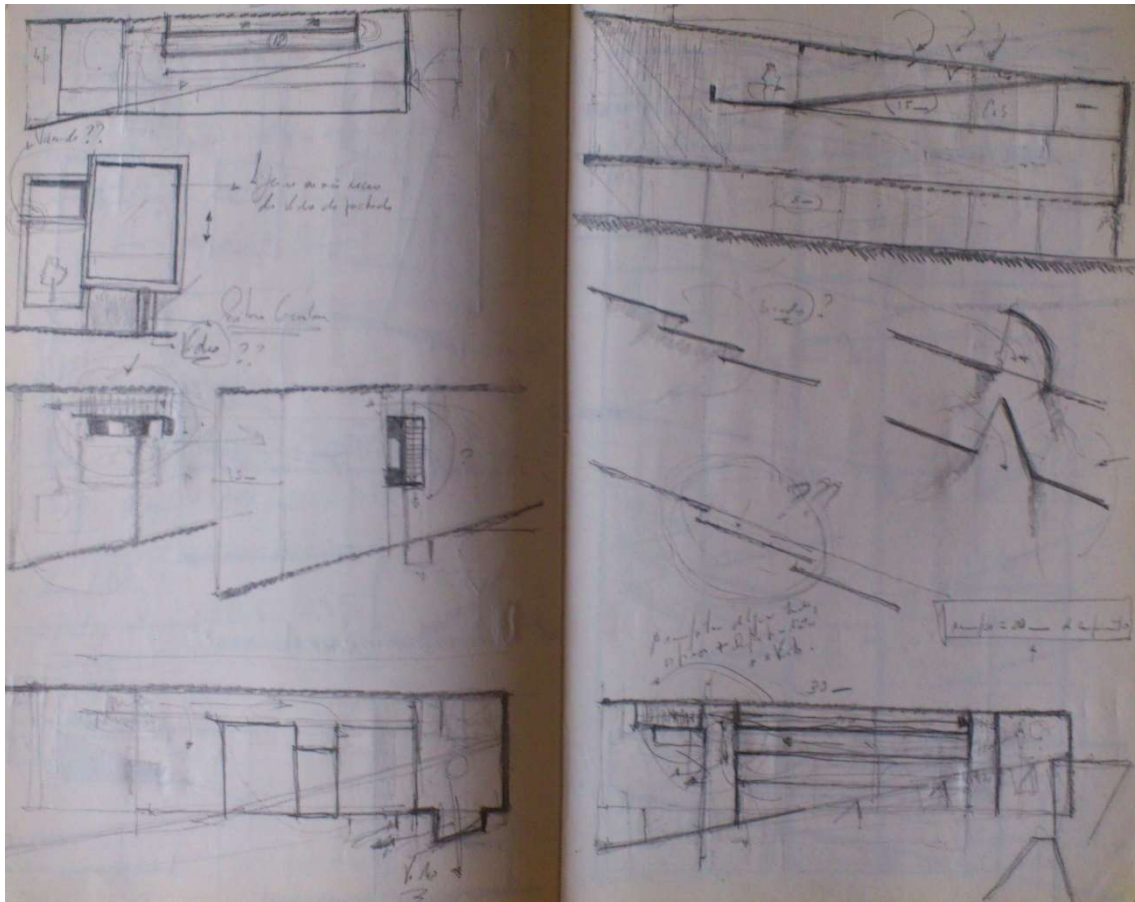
Plantas, cortes, alçados e detalhes arquitectónicos
